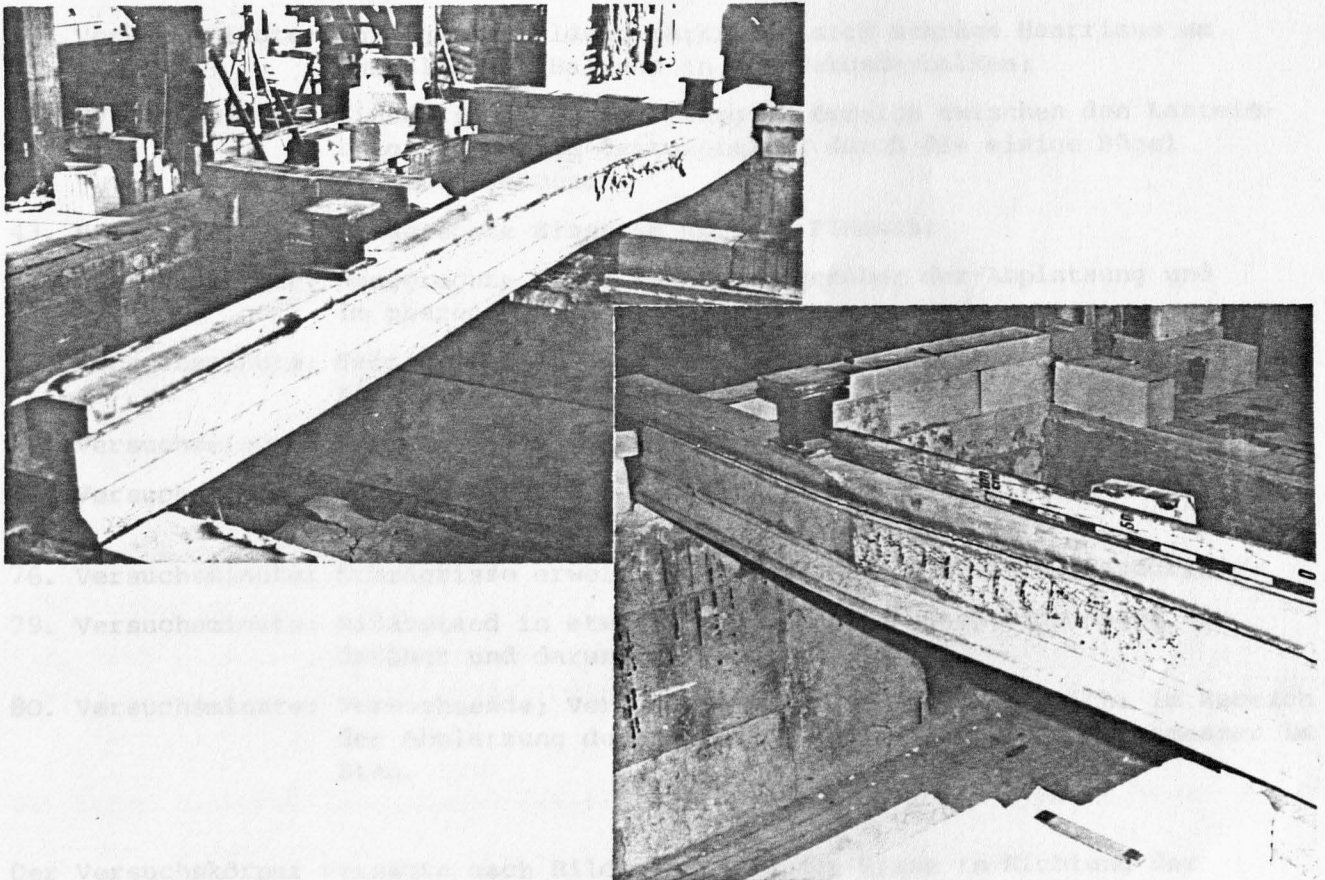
und 23: Schubbruchbereich des Balkens 16. Die Betondruckstreben sind - auch nach dem Abschlagen der Außenschale - gut zu erkennen
